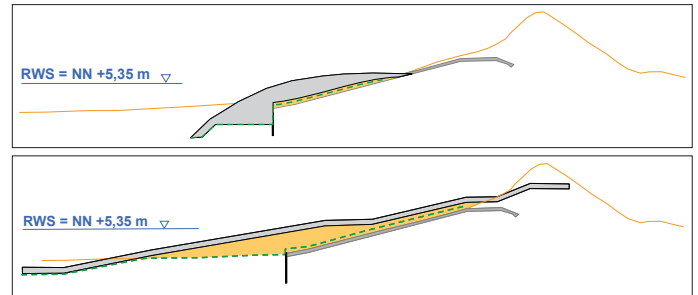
Sanierung mit Teil- und Gesamtüberbauung
